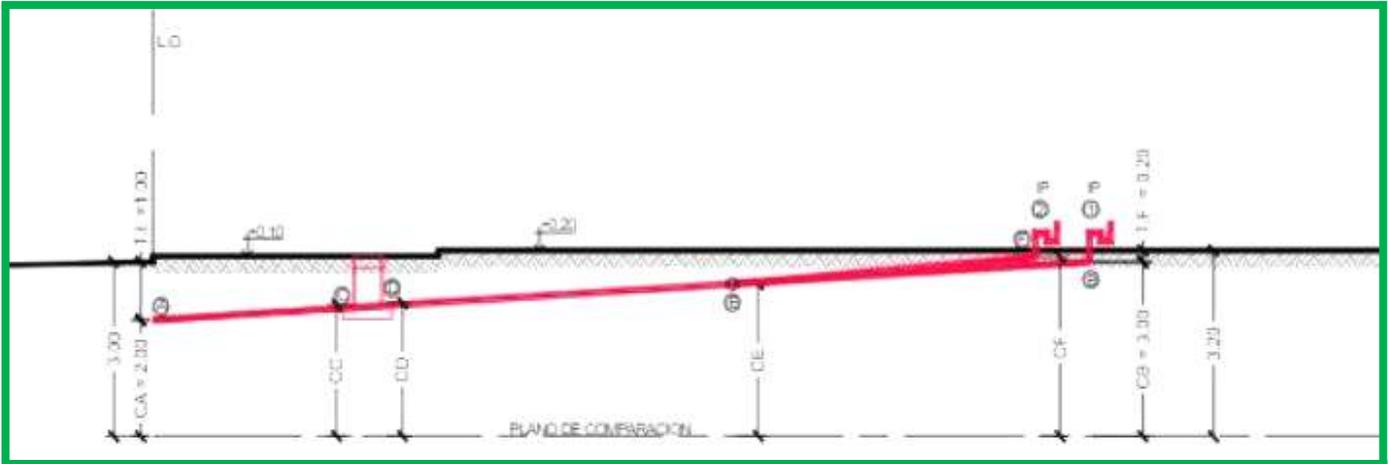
PLANO DEL PERFIL LONGITUDINAL CALCULADO PARA INSTALACIÓN DE LA CAÑERÍA.⁹
